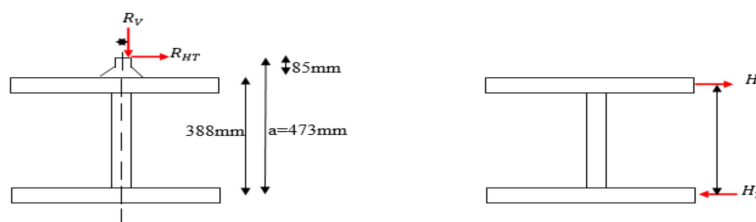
les forces horizontale et verticale appliquée sur la poutre de roulement.
